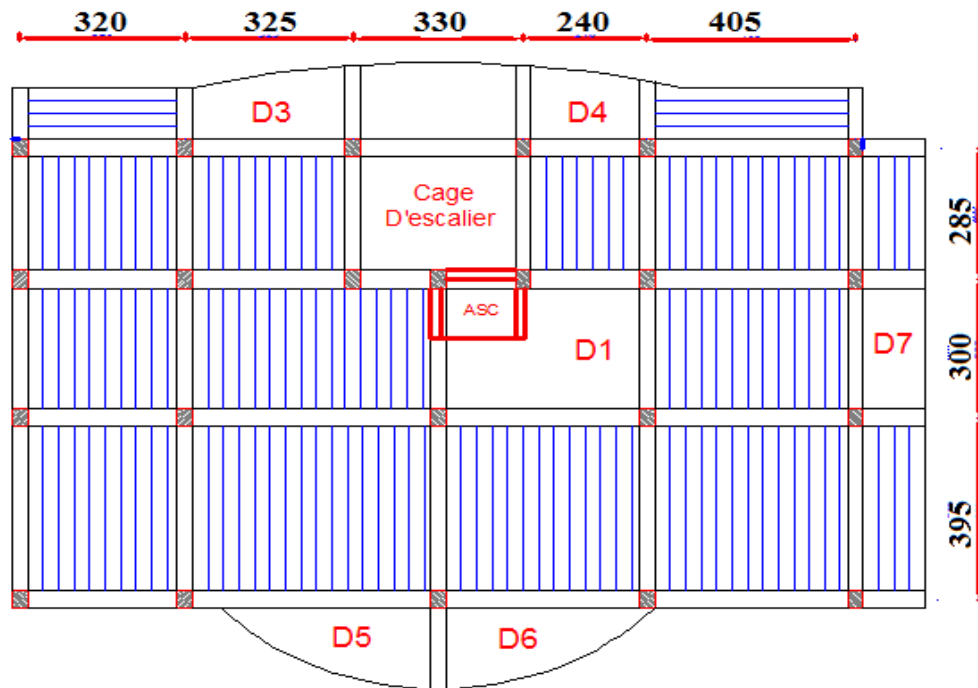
Schéma de la disposition des poutrelles de l'étage 9.
